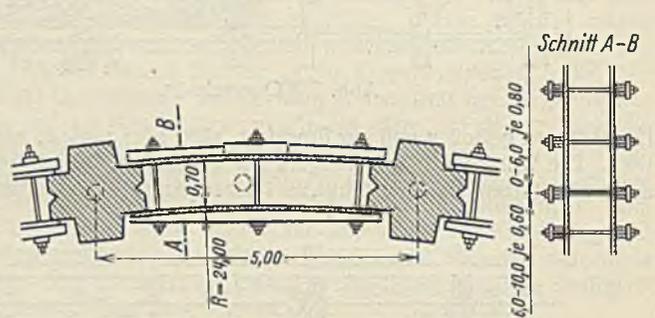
Fangdamm Beckholmen. Schalung und Guß des Gewölbes.
